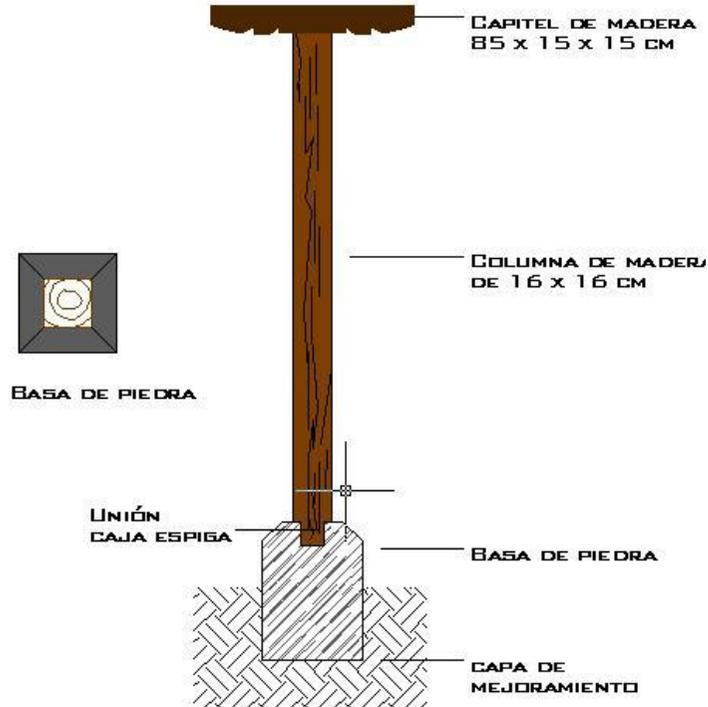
COLUMNA EMPOTRADA EN PIEDRA BASA
